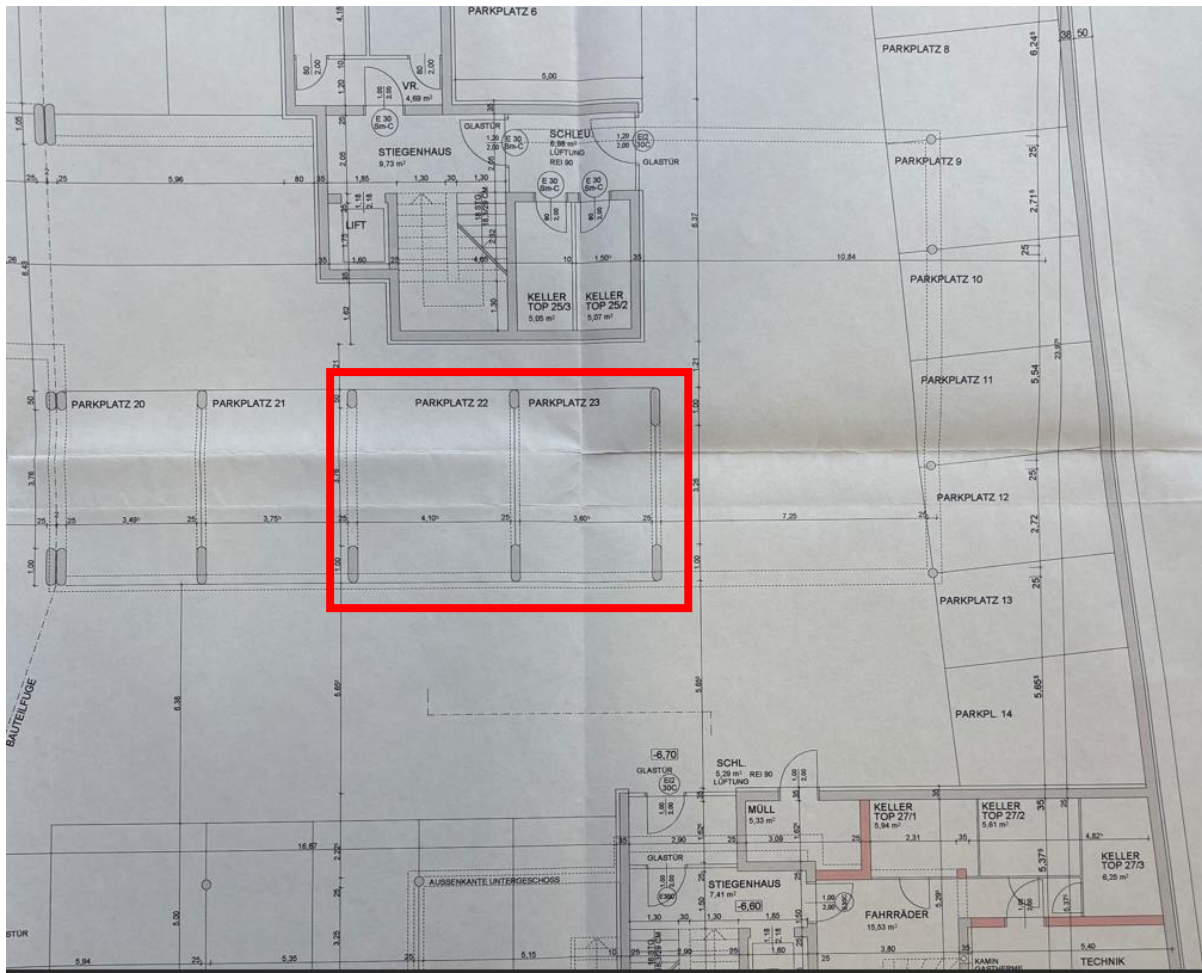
Grundriss Tiefgeschoss| Tiefgaragenstellplätze ¹⁹
